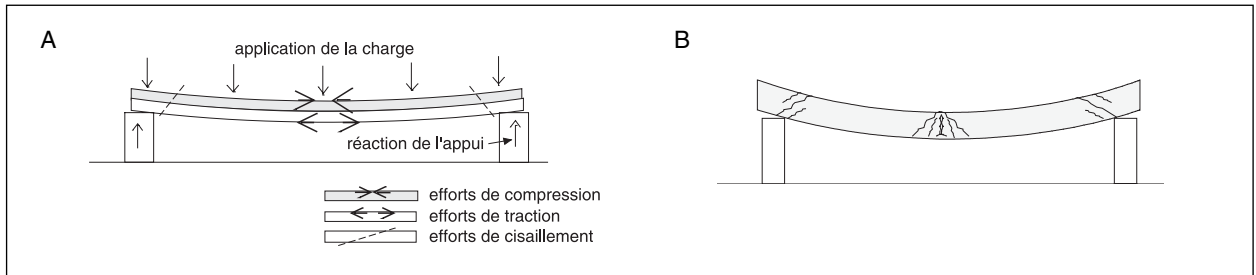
Poutre non armée sur 2 appuis simples supportant une charge uniformément répartie.
